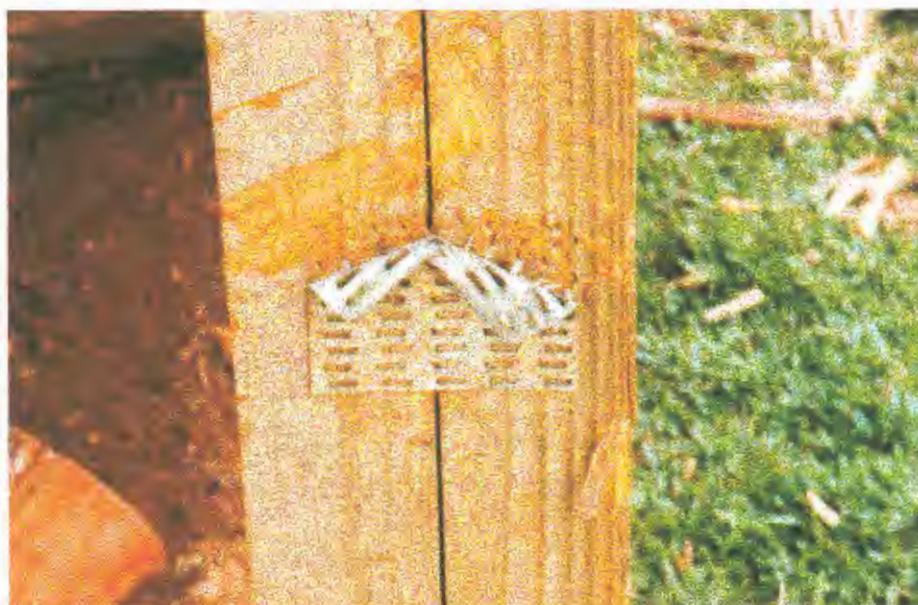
O arrancamento do conector metálico permite ver o perfeito estado de conservação da madeira.
